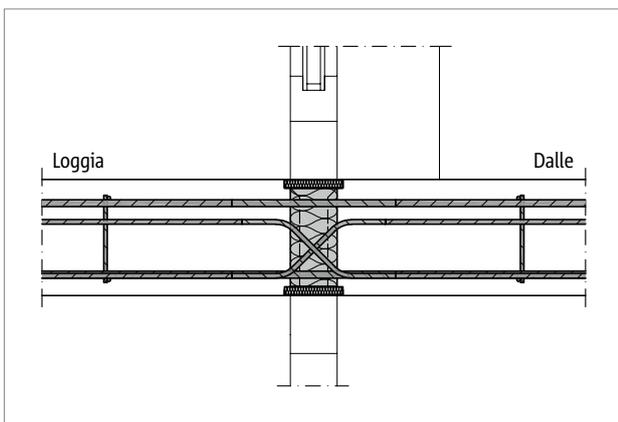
Schöck Rutherma® T type D : coupe de principe ; dalle portée sur deux appuis
